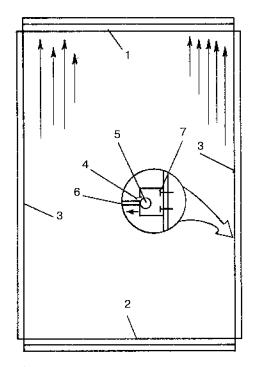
Способ закрепления краев пластиковой пленки натяжного потолка: 1 — крепление для натягивания; 2 — рейка опорного фиксатора; 3 — продольные рейки; 4 — продольный разрез; 5 — прочный шнур из капрона; 6 — пленка; 7 — фиксатор боковой рейки к несущей стене
